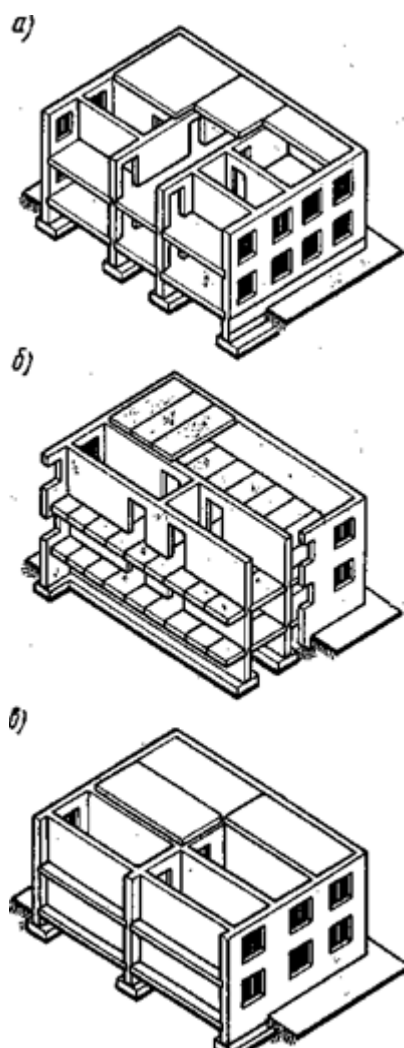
Конструктивные схемы бескаркасных зданий: а — с продольным расположением несущих стен; б — то же, с поперечным; в — смешанная
